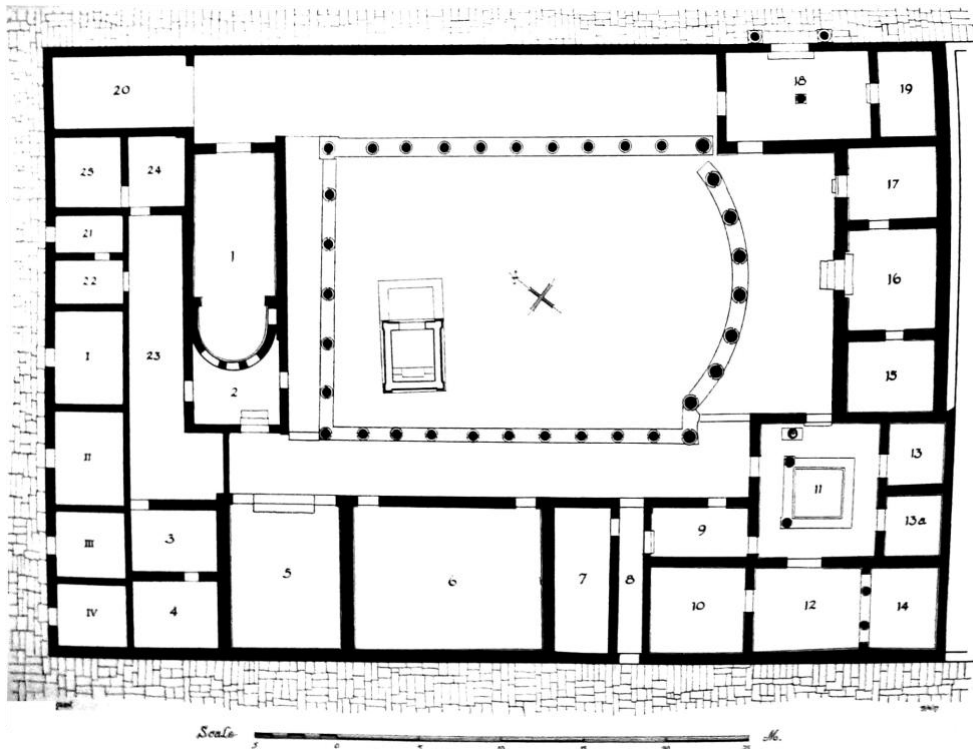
Planta de la Villa Romana de Ptolemais (Kraeling 1962, fig. 43, p. 121). En la habitación 14 (ángulo inferior derecho) se reconoce la planta de la “serliana”.
